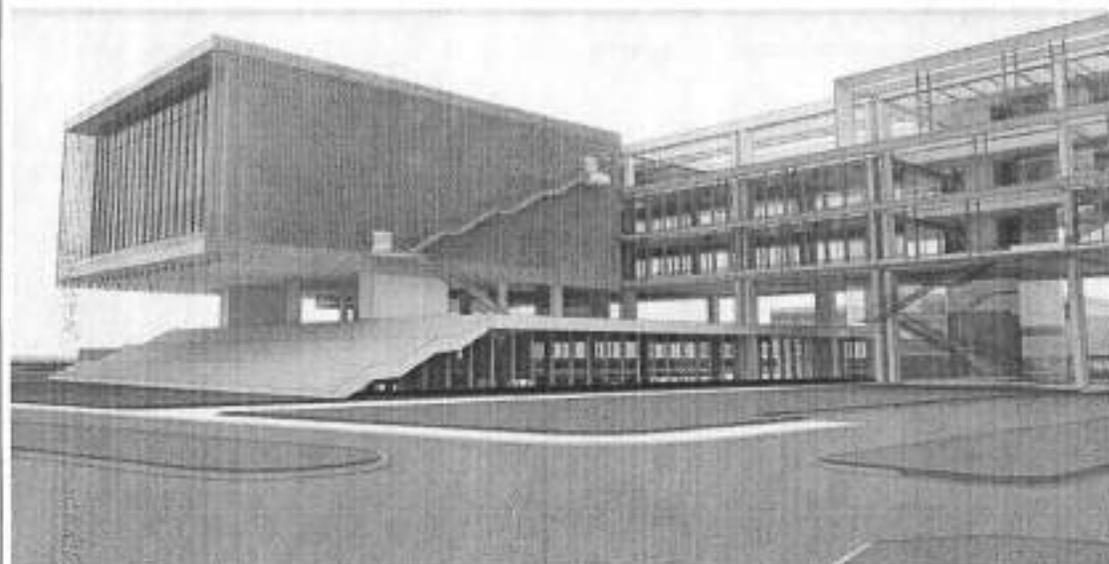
Vista de la biblioteca y el auditorio edificio de aulas
